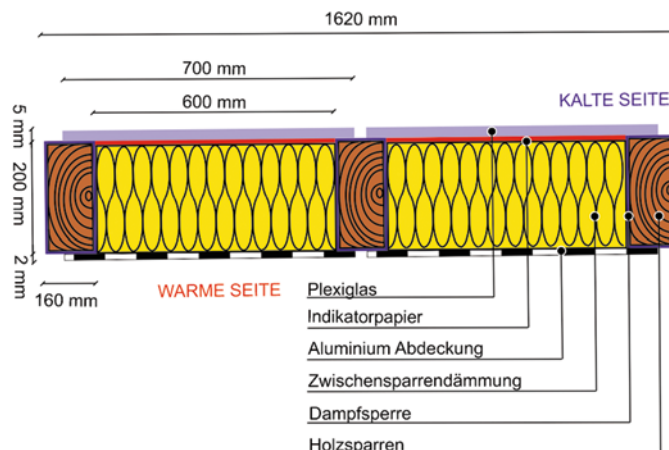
Aufbau der getesteten Holzständer-Leichtbaukonstruktion
